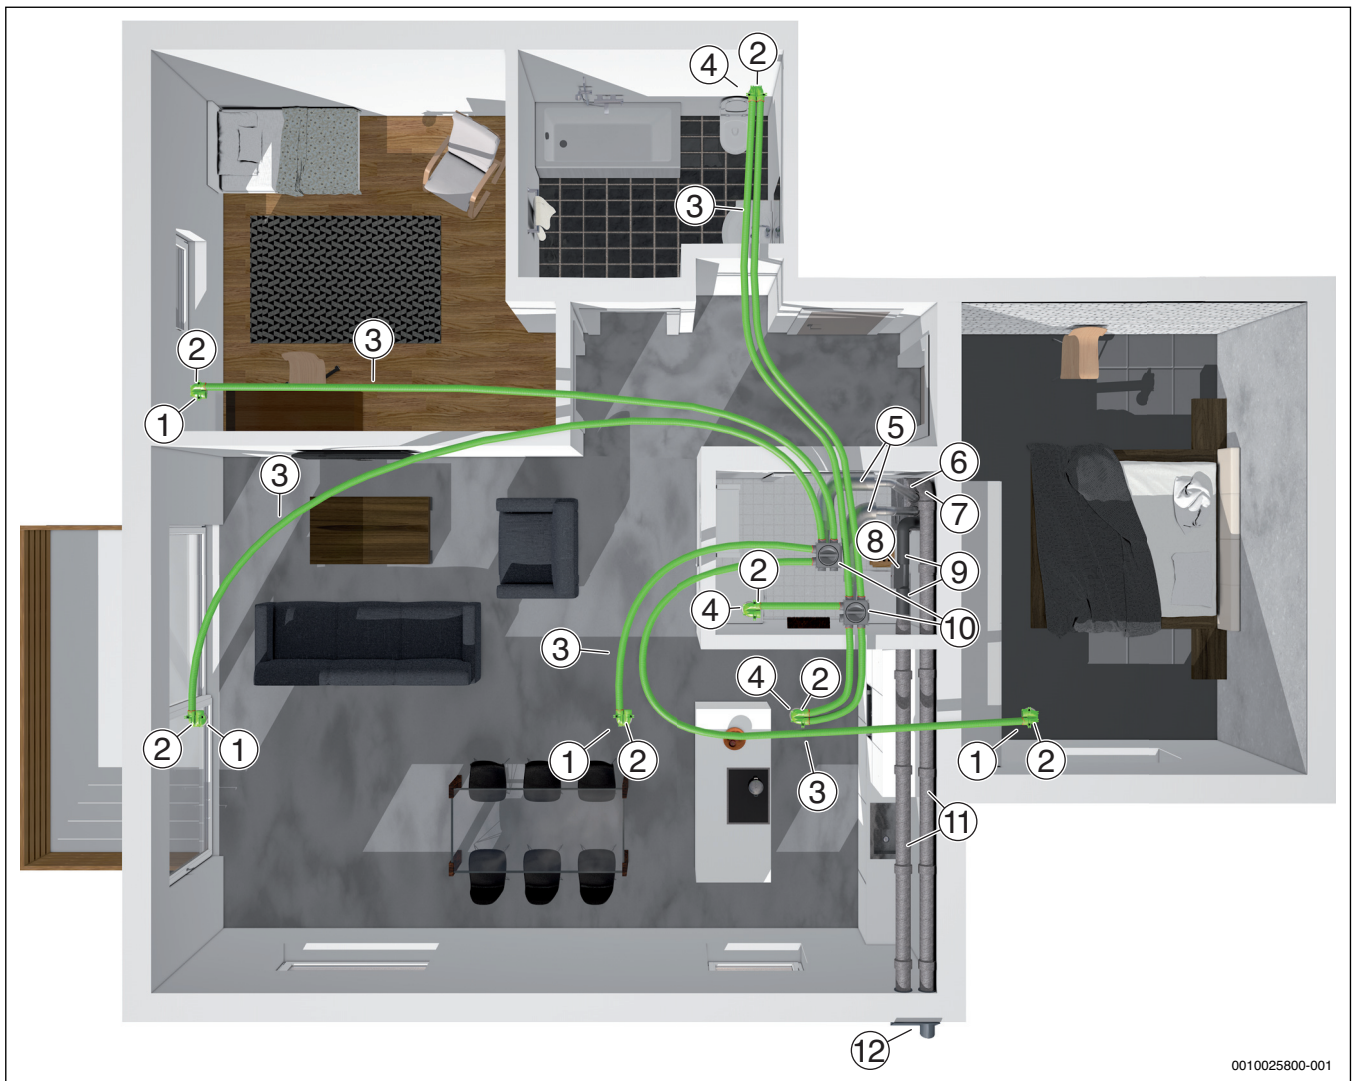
Anlagenbeispiel mit Zubehör – Deckeninstallation (z. B. im Altbau)
